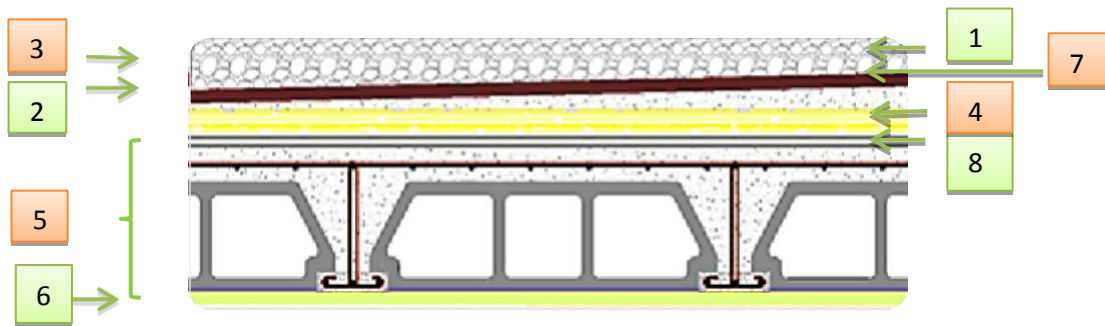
Composants d'un plancher terrasse en corps creux.
